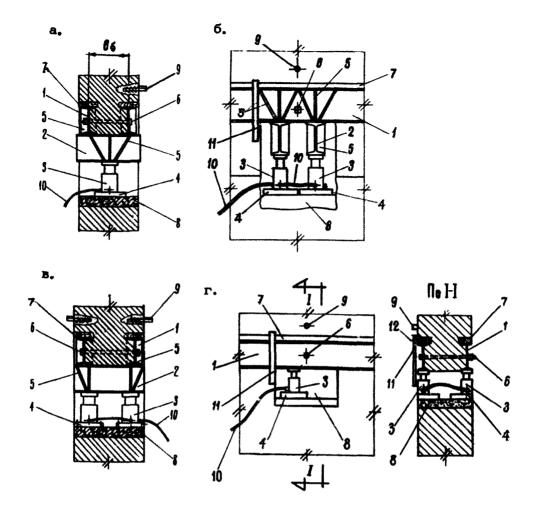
Схемы установки домкратов в нише: а-одиночного домкрата; б,в-спаренных домкратов в средней части стены; г- то же по краям стены.
